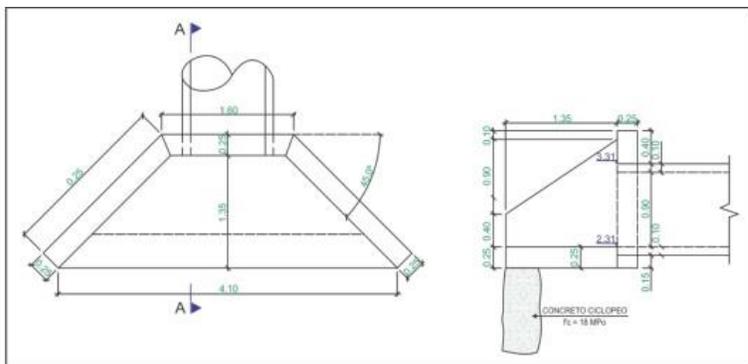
Elementos típicos de estructura terminal en alcantarillas: cabezote, aletas, solera y dentellón
